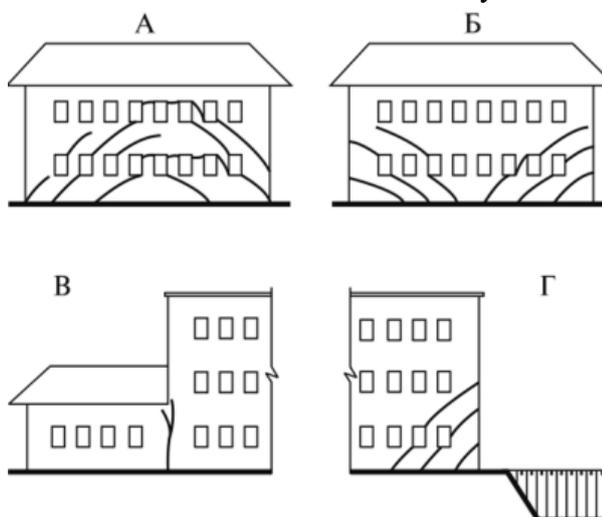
Характер трещин в наружных несущих стенах здания вследствие неудовлетворительного состояния оснований и фундаментов:
